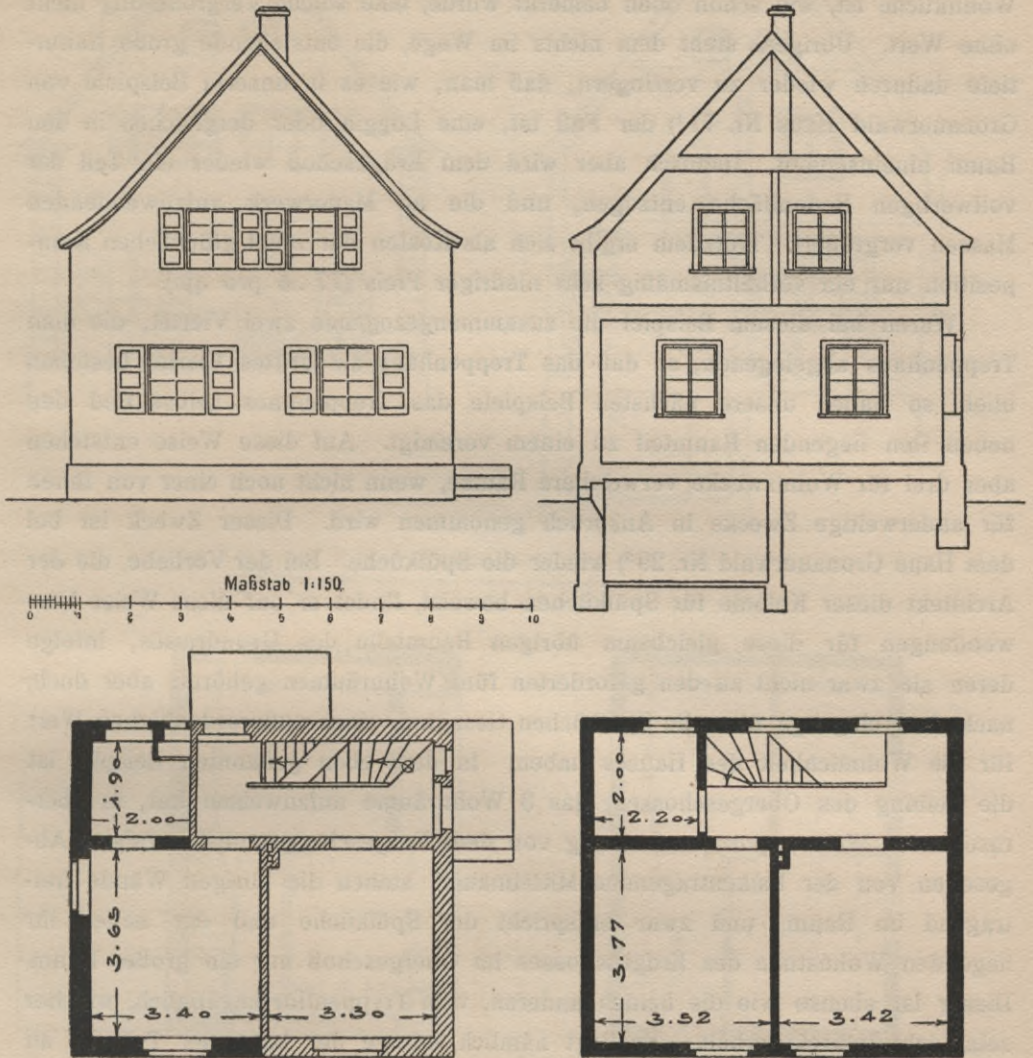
Typ 4b: Fünf Wohnräume, von denen zwei unten, drei oben liegen. Variante 1. Von vier Teilen des Erdgeschoßgrundrisses werden nur zwei zu Wohnungszwecken verwendet (Einzelhaus). Beispiel nach dem Hause in Gronauerwald, Berg-Gladbach Nr. 57. (Vgl. Gronauerwald, Berg.-Gladbach 1900—1906. Arch. L. Bopp.)
